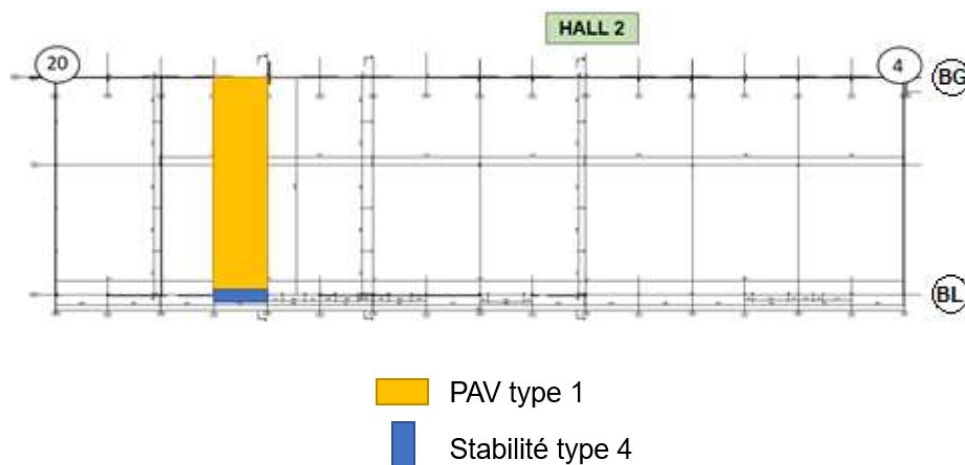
Emplacement des stabilités verticales et des poutres au vent – Extension hall 2
